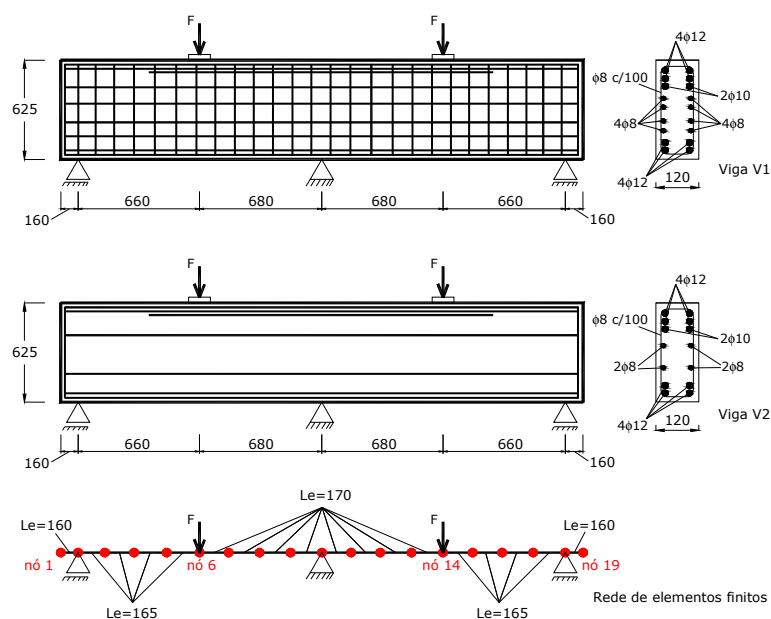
Detalhes das vigas analisadas V1 e V2 (unidades em milímetros)
